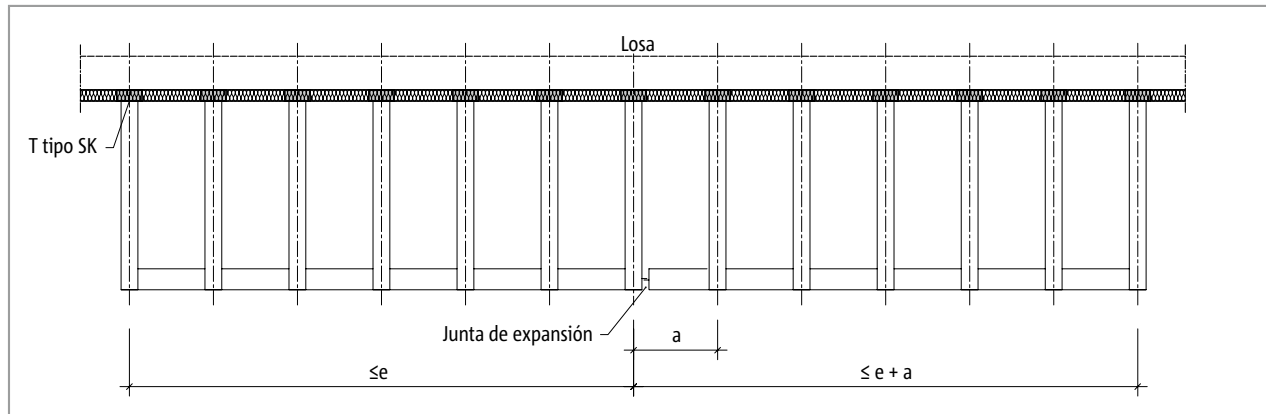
Schöck Isokorb® T tipo SK: Separación máxima de las juntas de expansión  $e$
